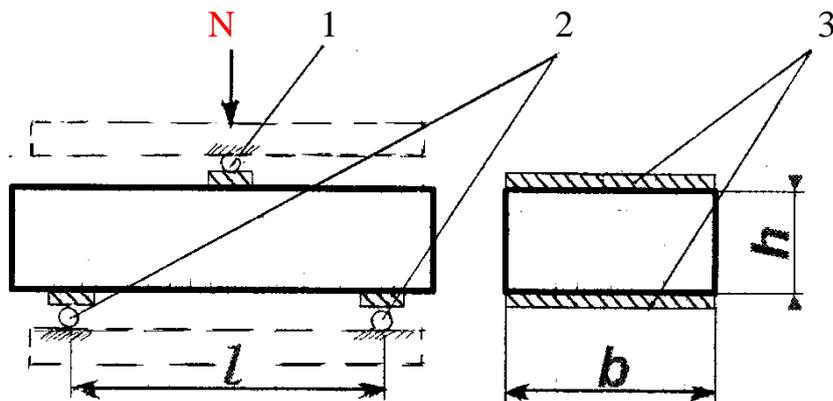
Схема испытания кирпича на изгиб: 1 – стержни цилиндрические стальные для восприятия нагрузки при испытании; 2 – места опирания образца на упоры; 3 – слой цементного раствора состава 1:3 толщиной 3–5 мм; N – разрушающая нагрузка
